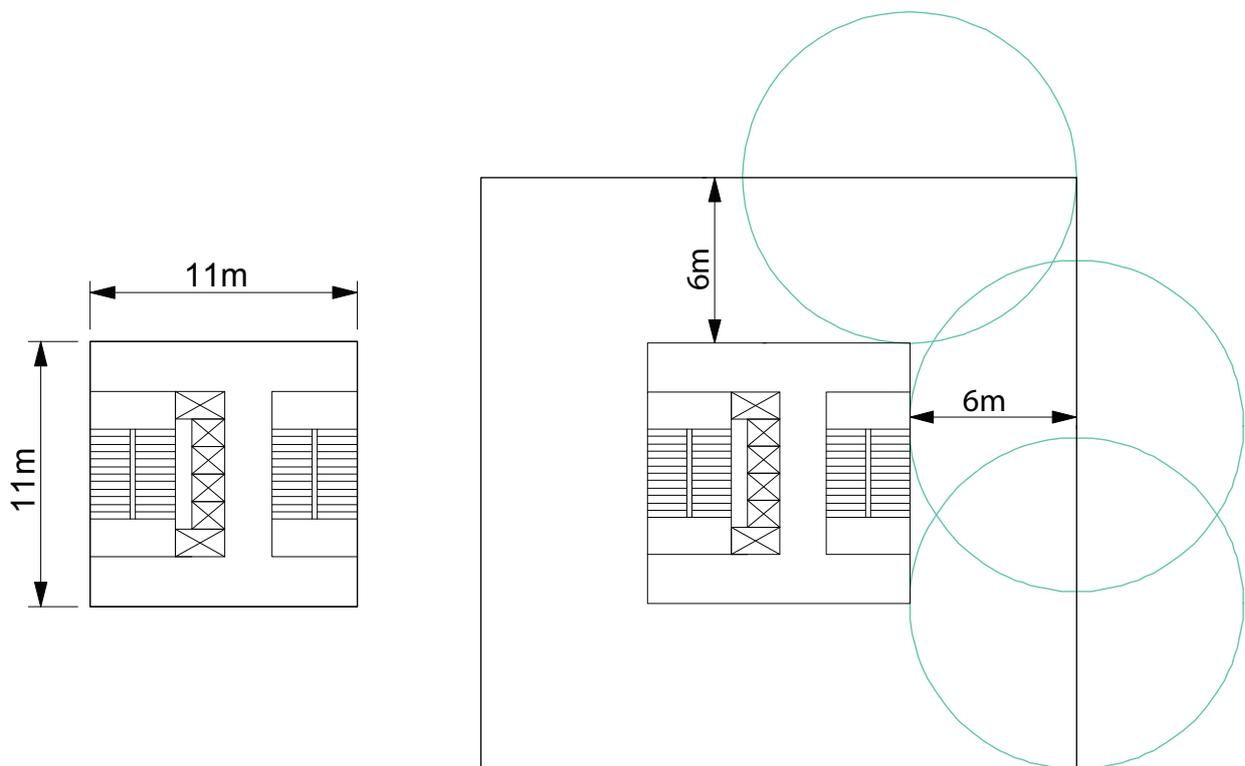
Grundriss Absolute Towers, Mississauga
